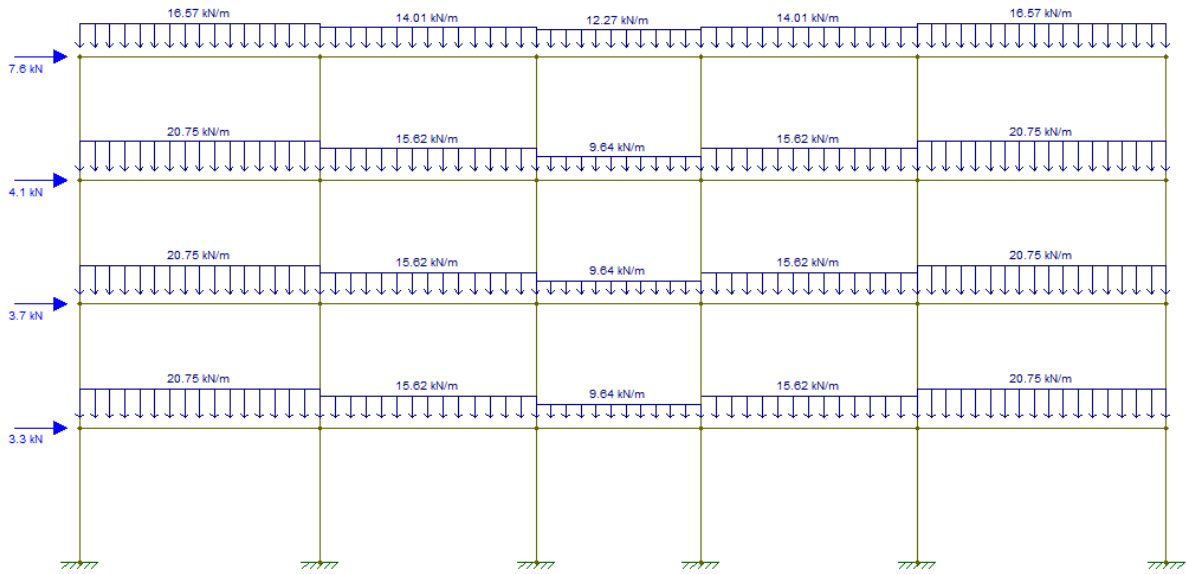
Pórtico 1 carregado, vigas V1 e V4.
